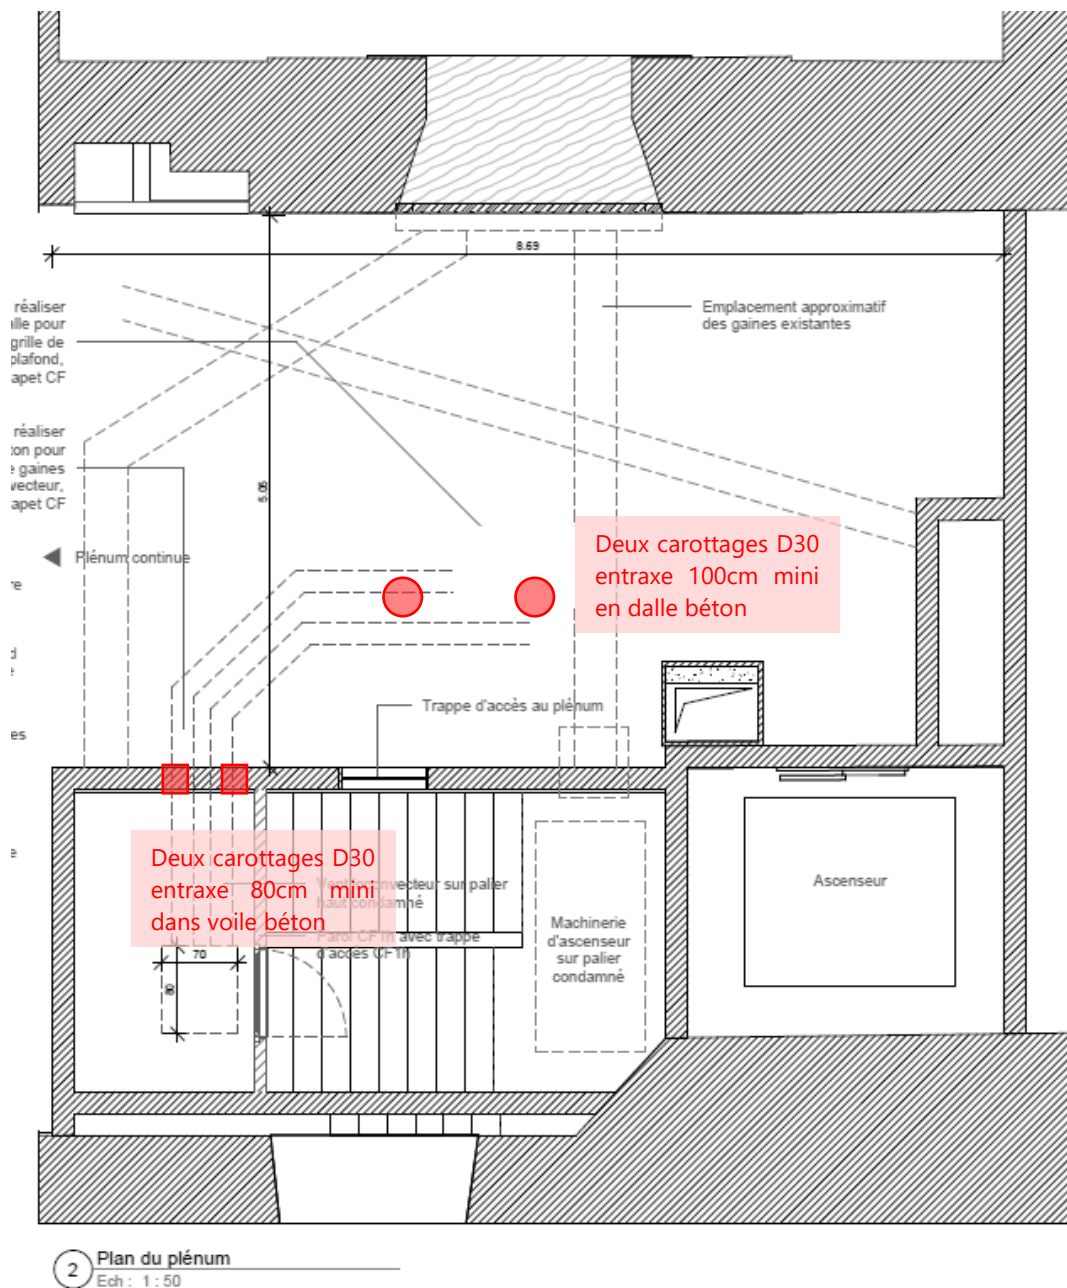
Plan projet – repérage des carottages à réaliser en mur et plancher
